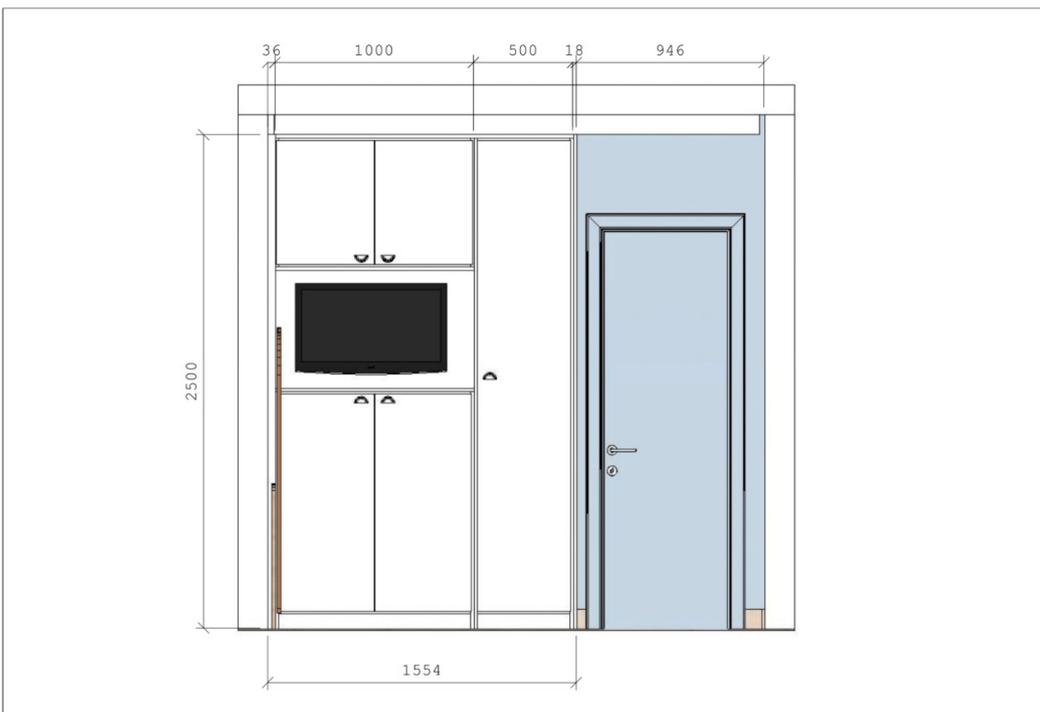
Detalhamento imagem 3. Fonte: Autora.
